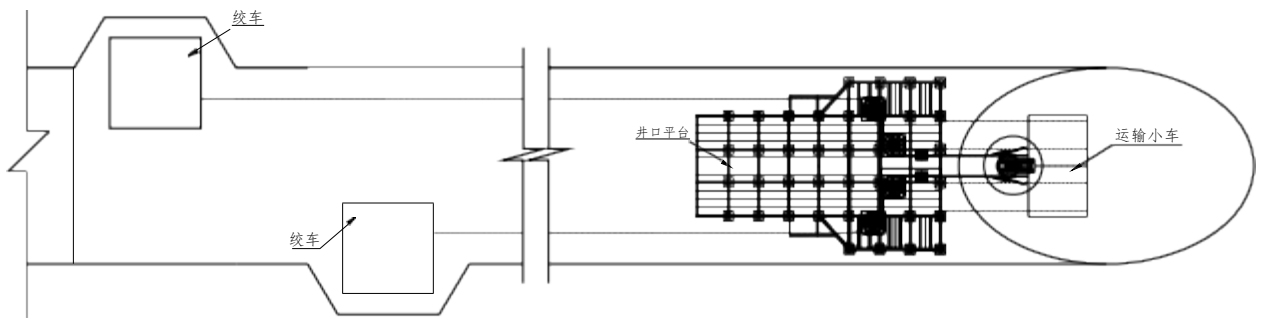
斜井灌浆运输小车提升系统平面布置示意图
